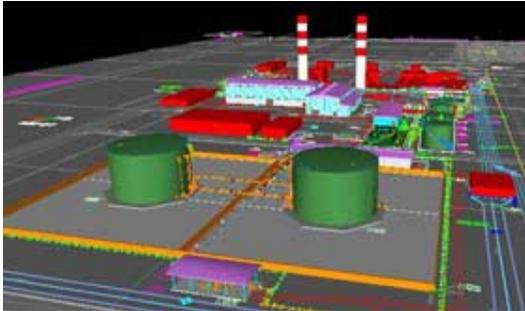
Ejemplo de Plot Plan de una planta petrolera, Fase de Ingeniería Conceptual.
